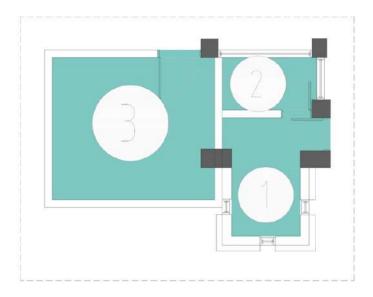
Planta 1 Bloque 45. Fuente: Equipo de diagnóstico.
